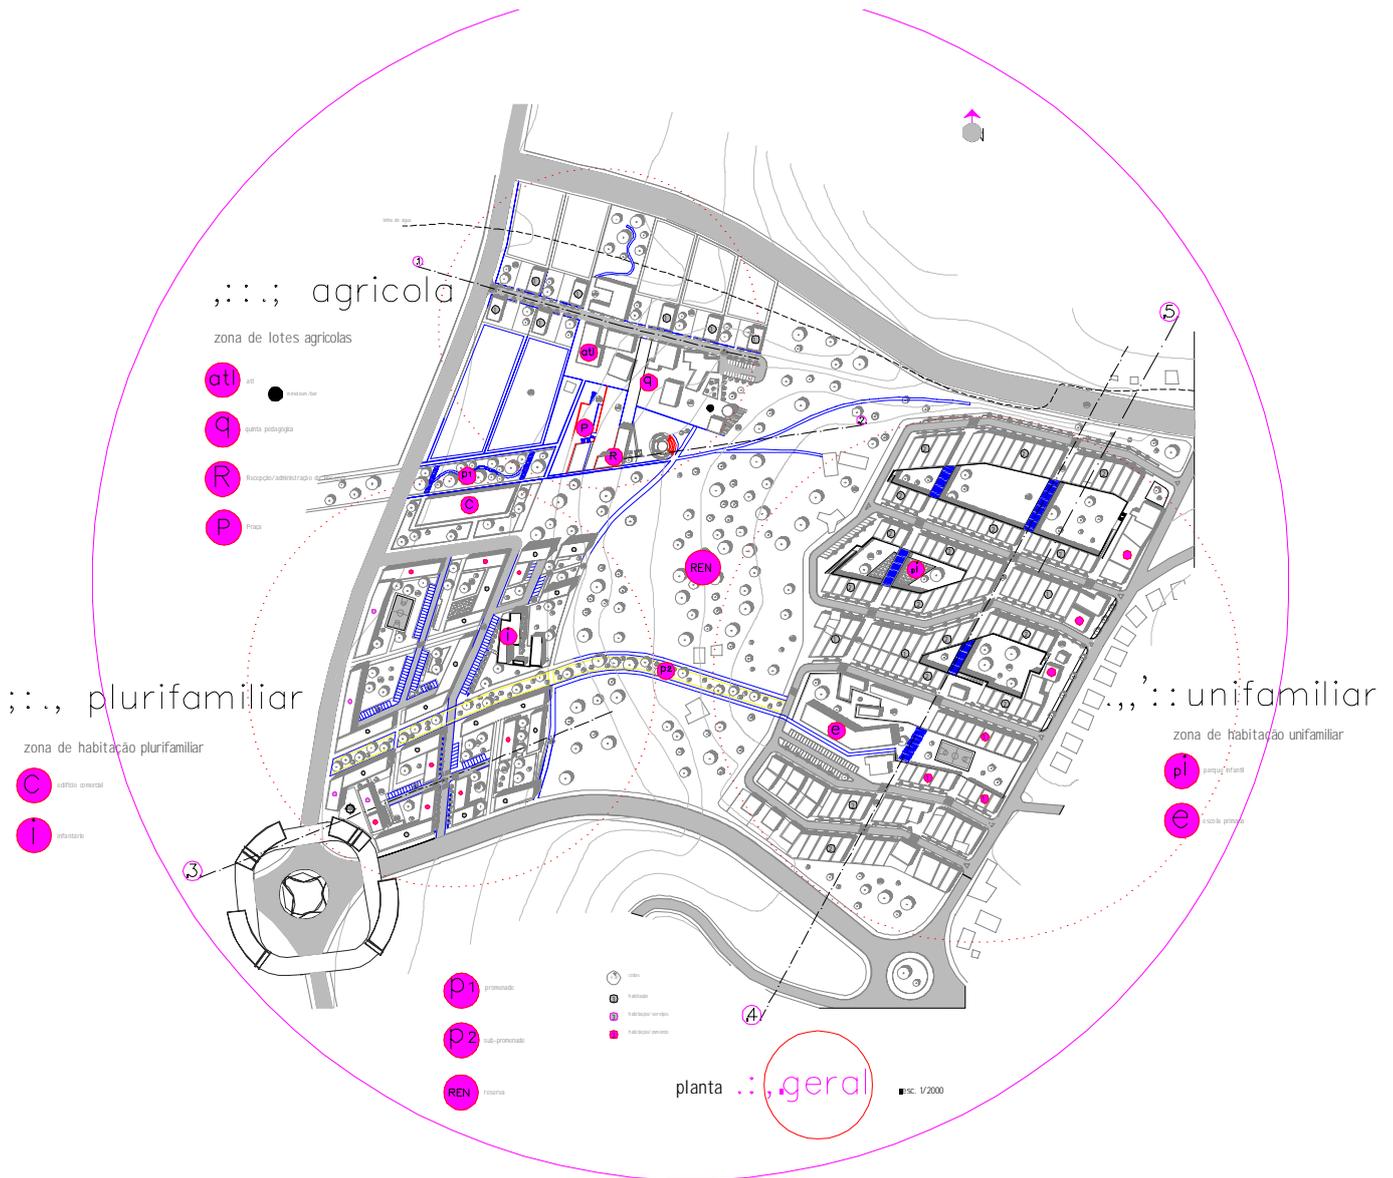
Plano de detalhe X-Tema – Planta geral do plano elaborada à escala 1/2000.
